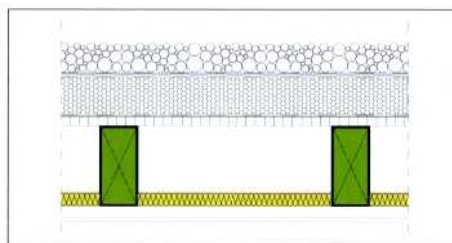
Flachdach GK 0 nach DIN 68 800-2 mit raumseitiger Bekleidung: Wärmeschutz überwiegend oberhalb der Decke angeordnet (Dämmmaterial beliebig), keine dampfsperrenden Schichten innerhalb des eigentlichen Deckenquerschnitts, an der Deckenunterseite möglichst diffusionsoffene Bekleidung (Gipsplatten, Brettschalung), evtl. zusätzliche Dämmschicht im Gefach aus mineralischen Faserdämmstoffen nach DIN 18 165-1 oder von Dämmstoffen mit Verwendbarkeitsnachweis
